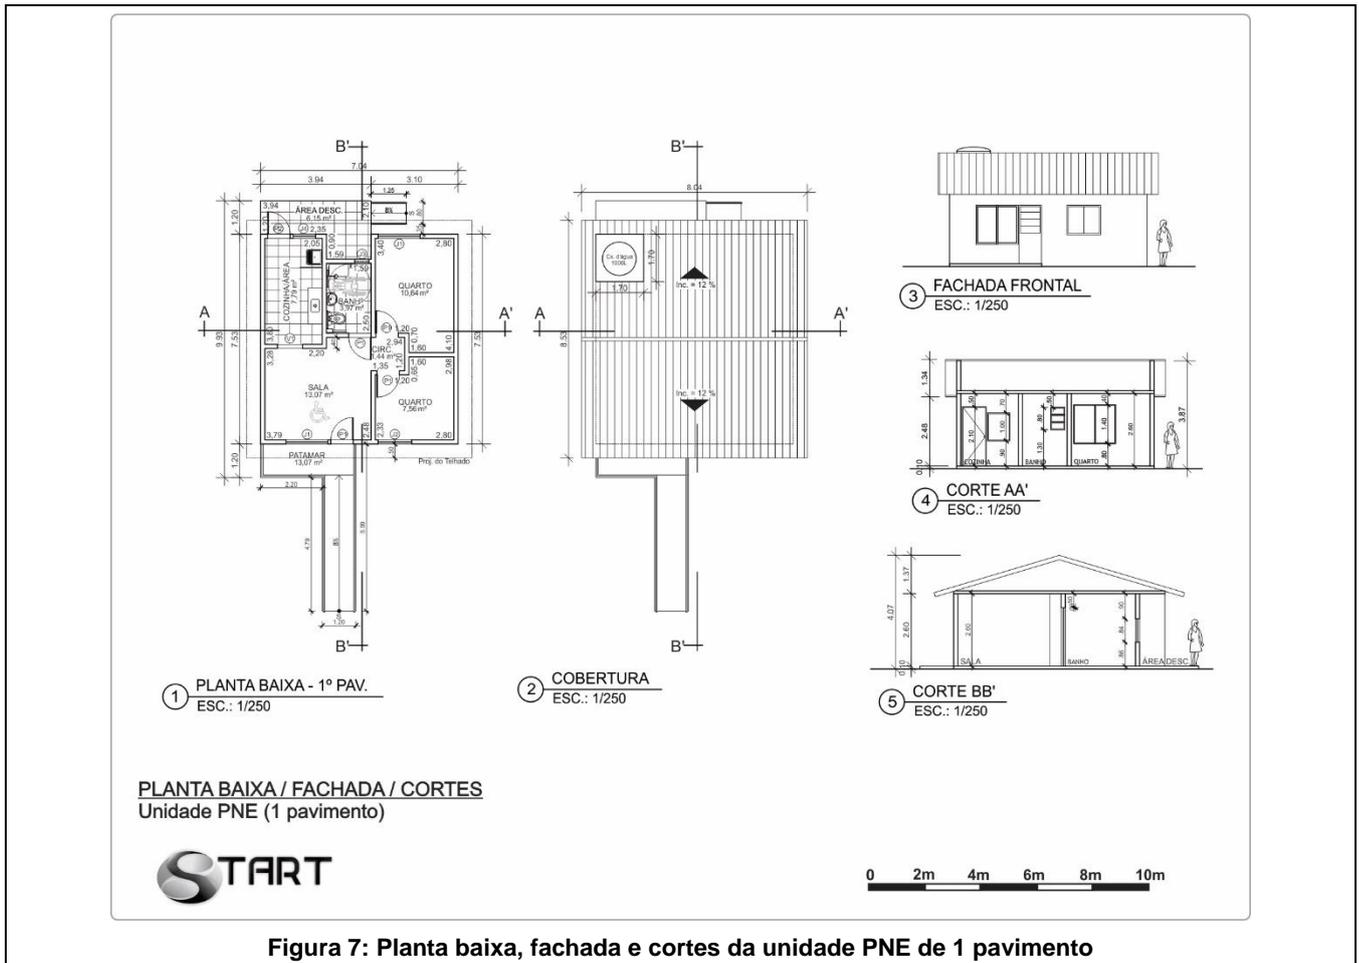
Planta baixa, fachada e cortes da unidade PNE de 1 pavimento
